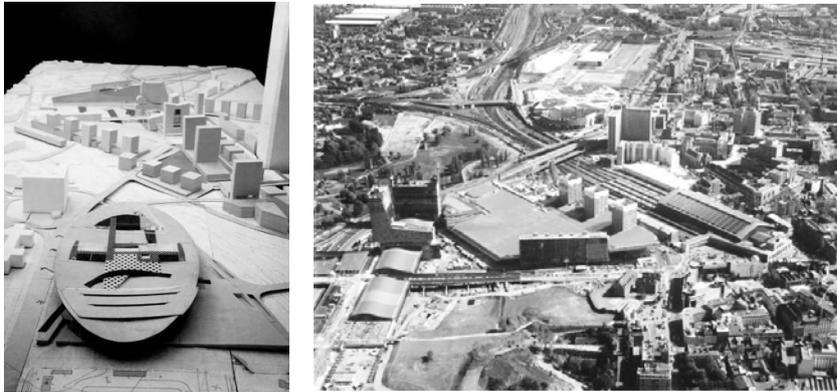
OMA, Euralille 1989/1994. Maqueta del conjunto con el Congrexpo en primer plano / Vista aérea del proyecto en construcción: El Congrexpo se ve en el centro arriba de la imagen.
